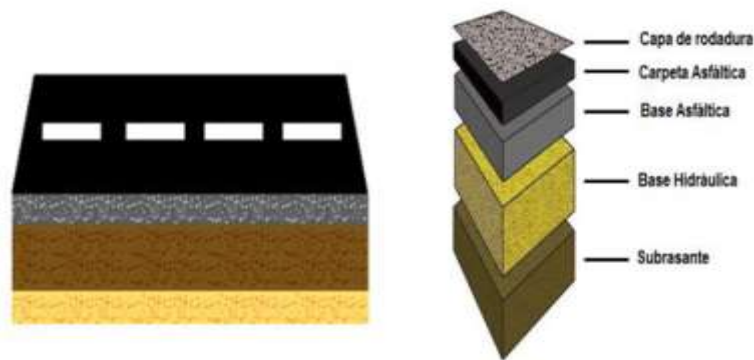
Estructura de un pavimento flexible (BUAP, 2018)
